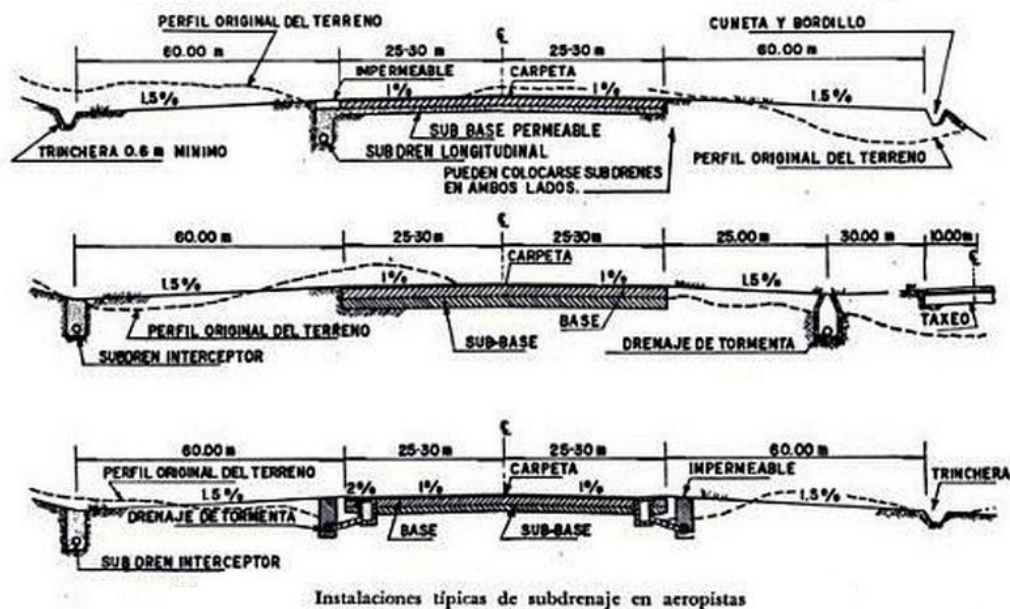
Instalación de drenes longitudinales en terrenos planos.
